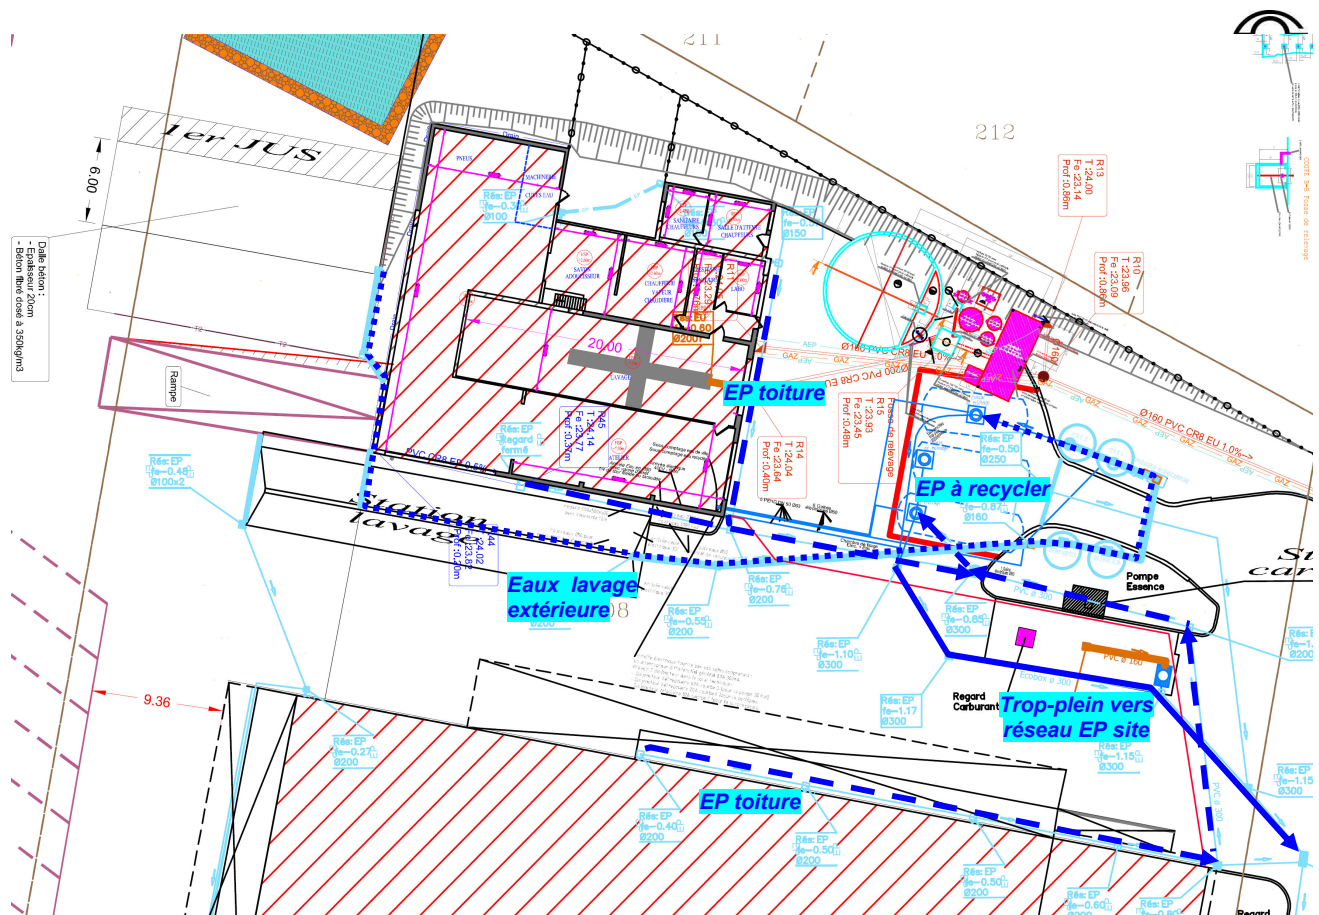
PLAN DU RESEAU D'EAU RECYCLEE
